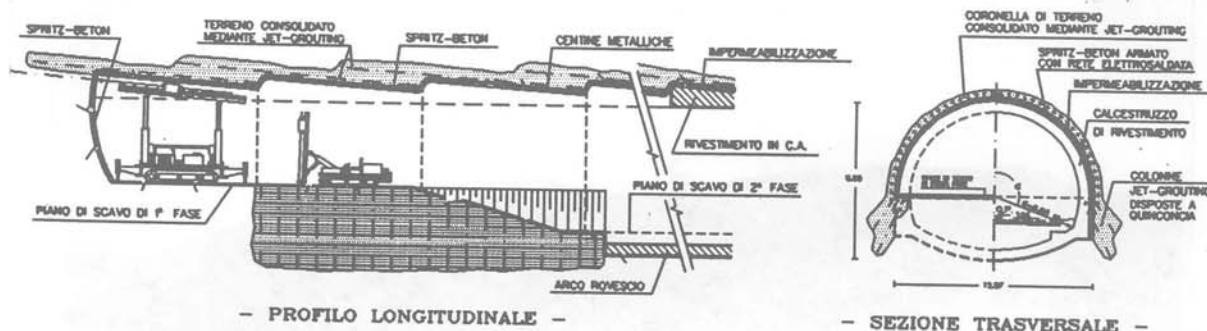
Sezione tipo, schema di avanzamento ed esecuzione jet-grouting sub-orizzontale.
